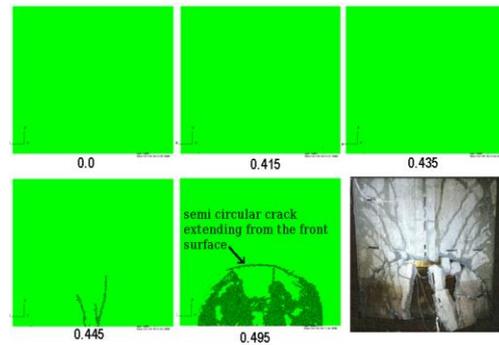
コンクリート壁背面におけるひび割れパターン (右下は実験)
